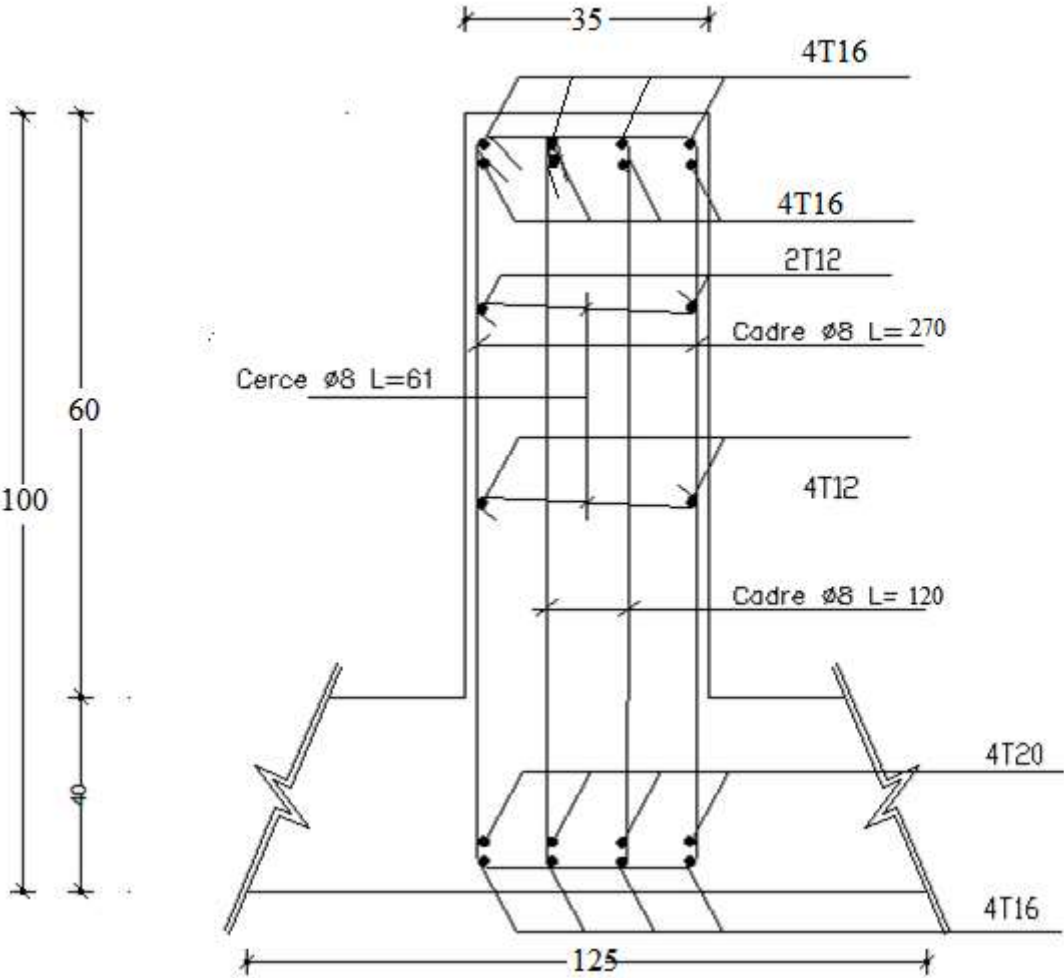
Ferrailage de la poutre principale en appui .
